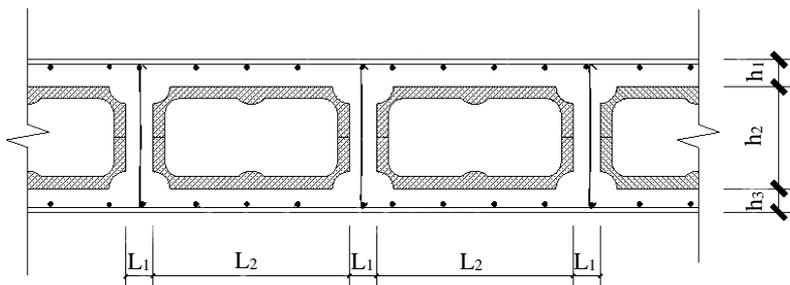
磷建筑石膏模盒现浇混凝土空心楼盖剖面示意
